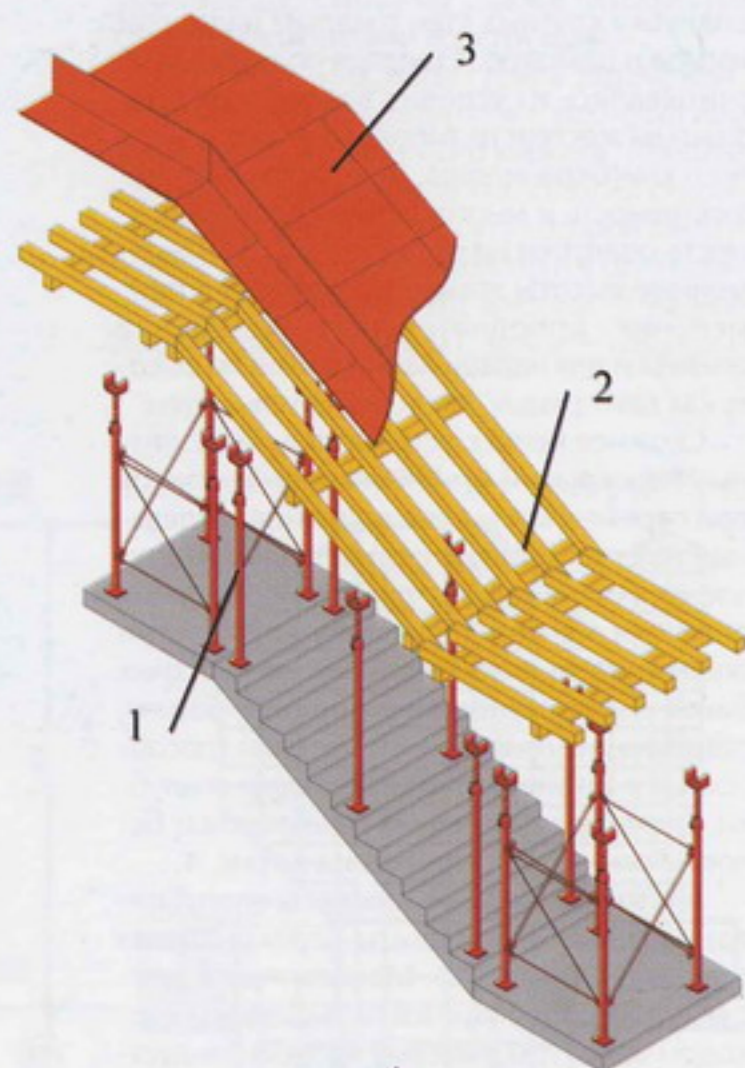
Схема опалубки монолитных лестниц: 1 — опорная система; 2 — система опорных балок; 3 — палуба из водостойкой фанеры
